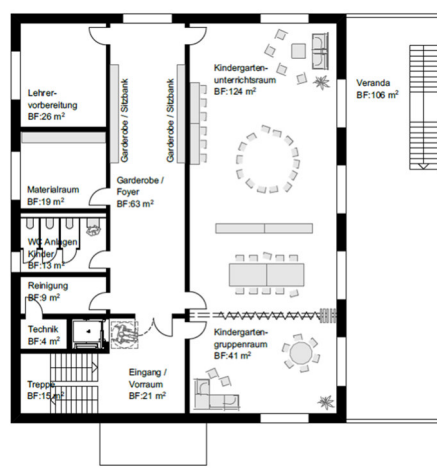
Disposition 2.1 | Grundriss 1. Obergeschoss
